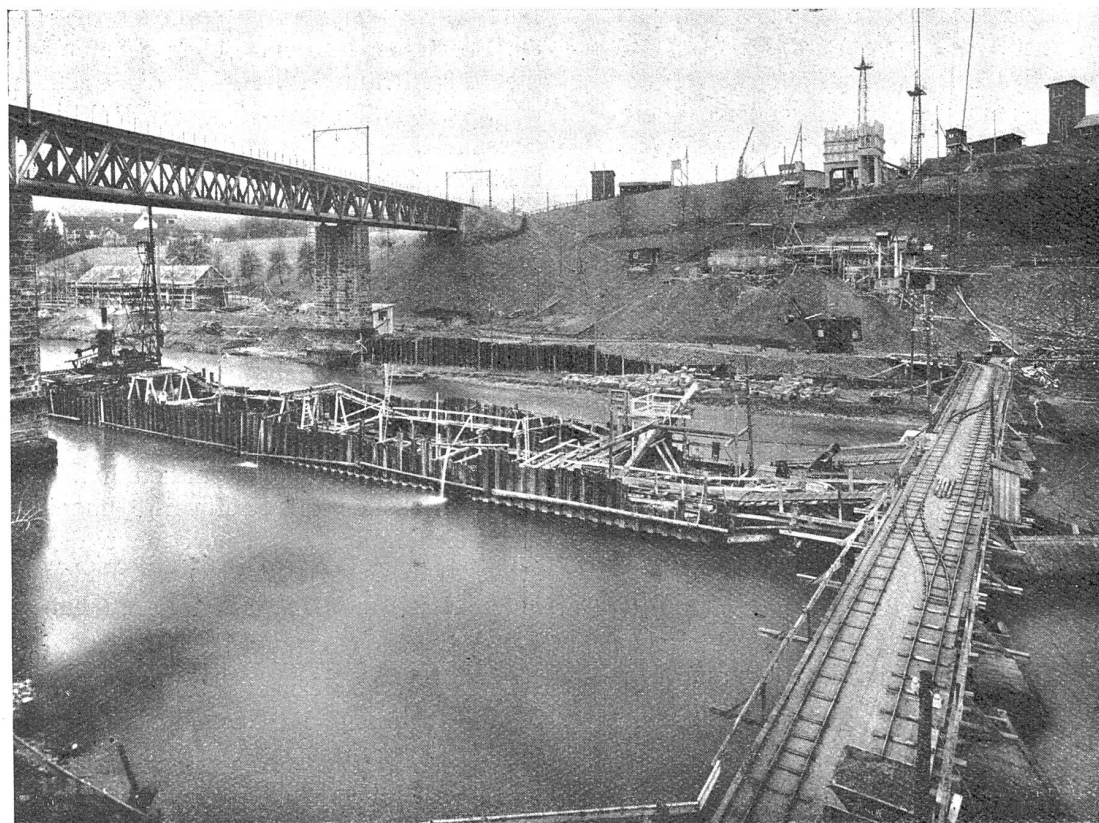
Kraftwerk Wettingen. Stauwehr und Maschinenhaus. Fundation des mittleren Wehrpfeilers. Mauerung der Nordwand des Maschinenhauses und Bau der Betonieranlage.
